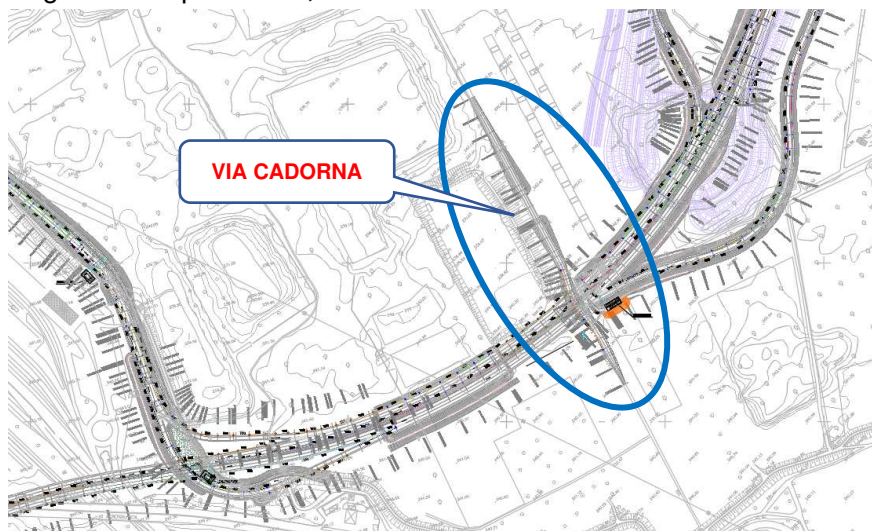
Planimetria con individuazione della viabilità secondaria via Cadorna.
